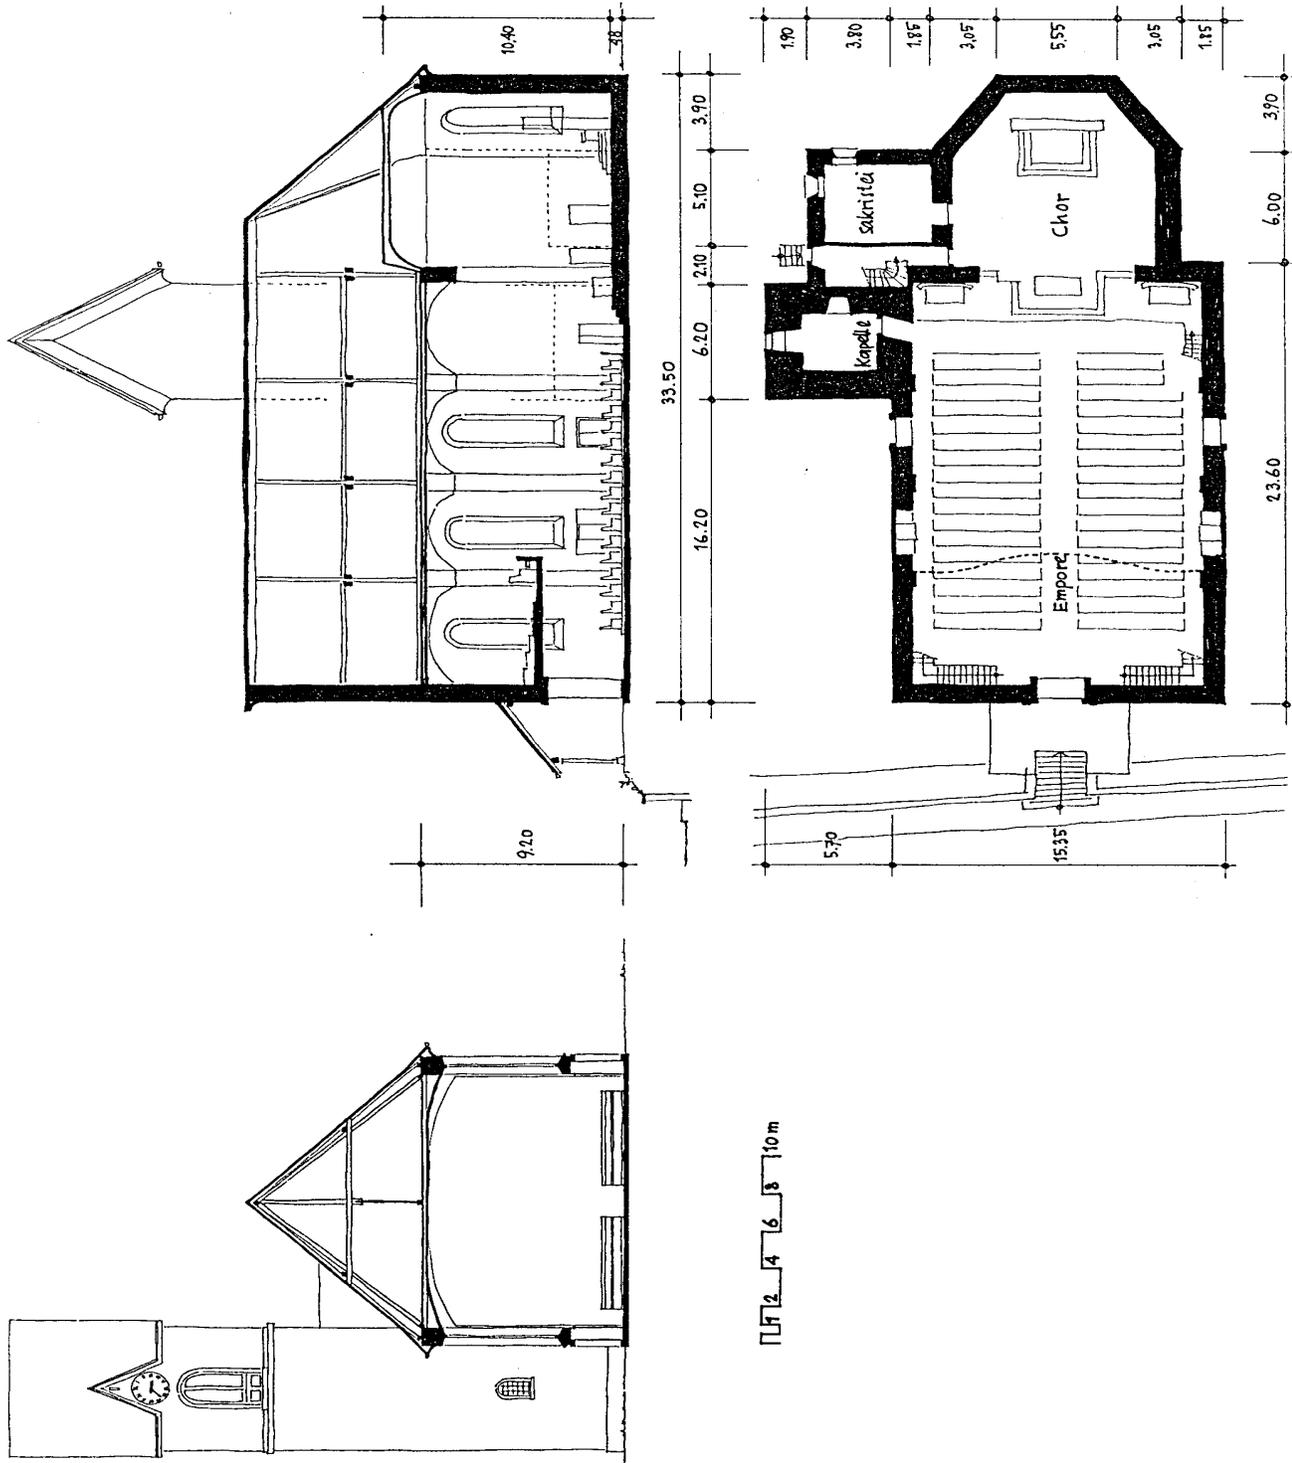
Grundriss und Schnitte katholische Kirche Goldingen
